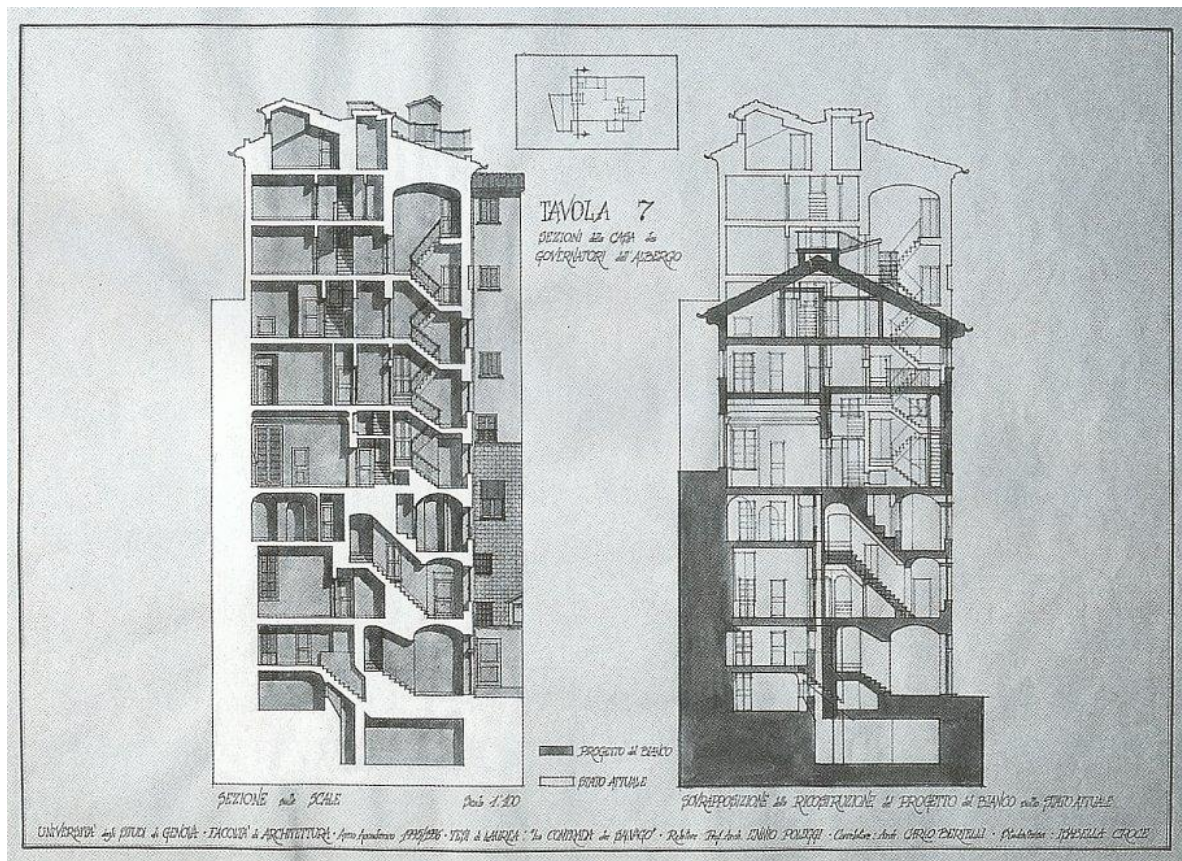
Sezione sulle scale; a destra sovrapposizione, sullo stato attuale, della ricostruzione del progetto del Bianco.
